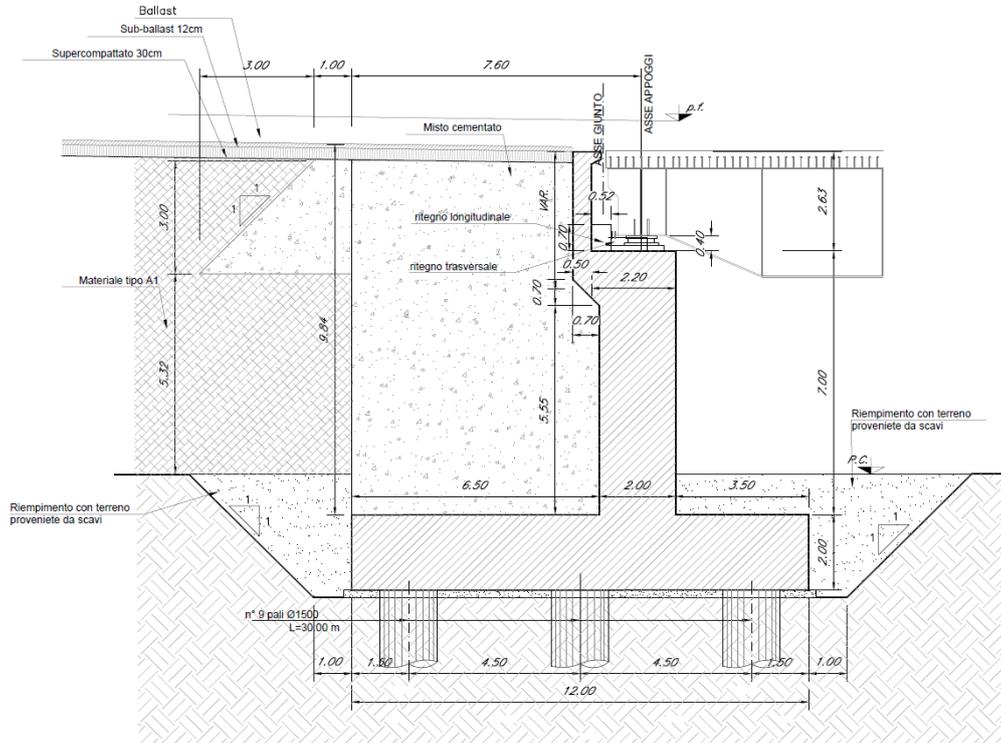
Sezione longitudinale (in asse tracciamento) della spalla
